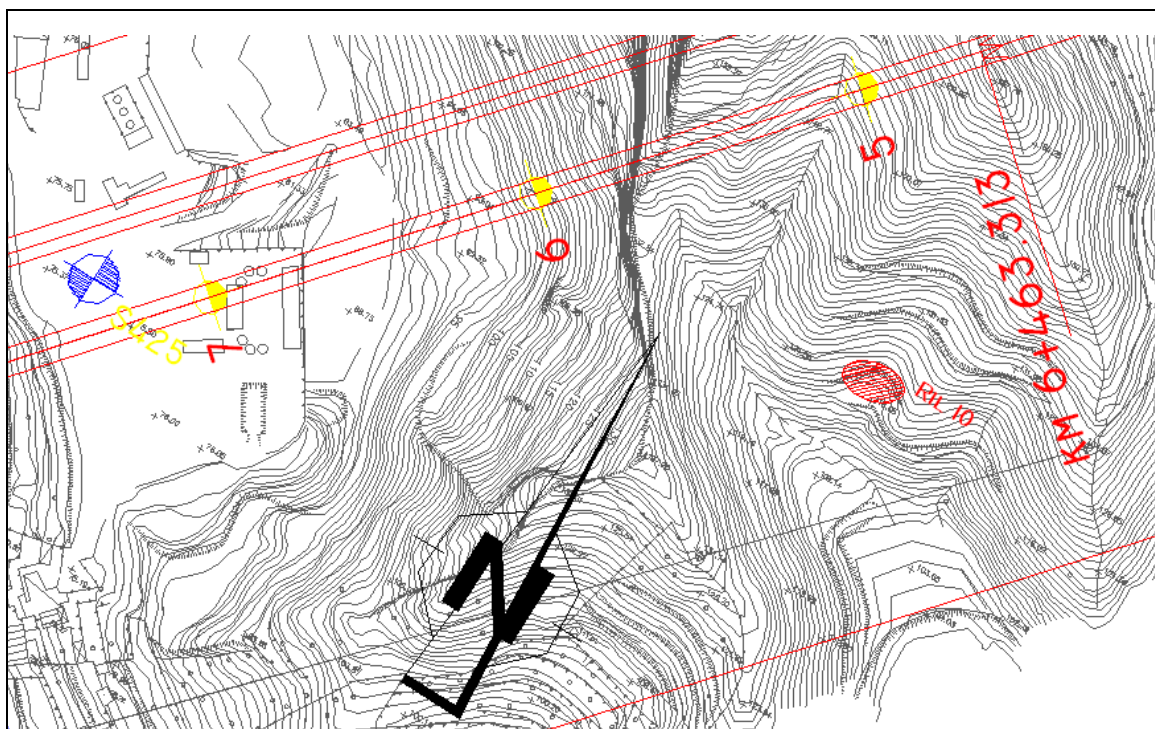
Ubicazione in planimetria dell'affioramento oggetto del rilievo geostutturale
